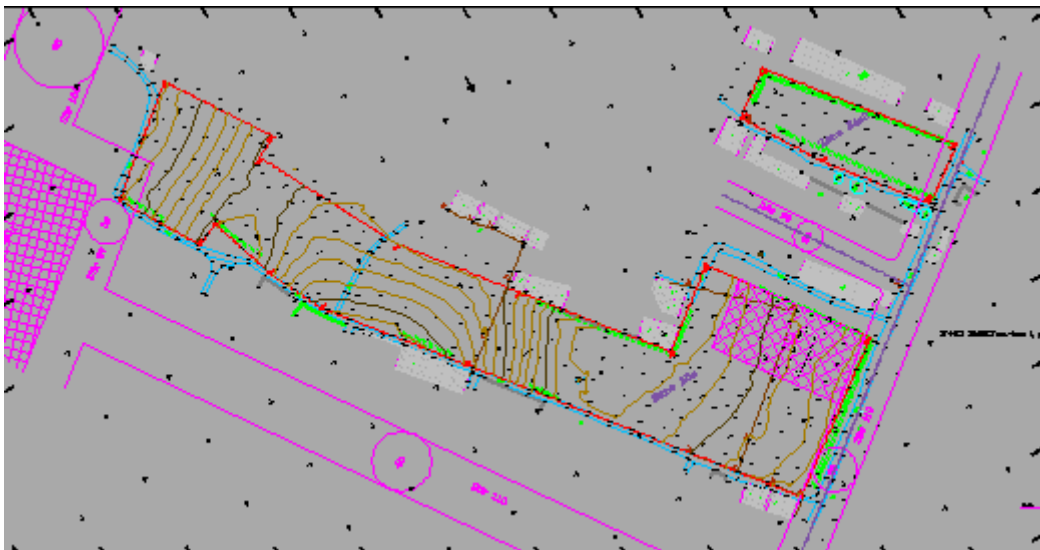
plan coté des parcelles P1 et P2 du lotissement M.I.A.
